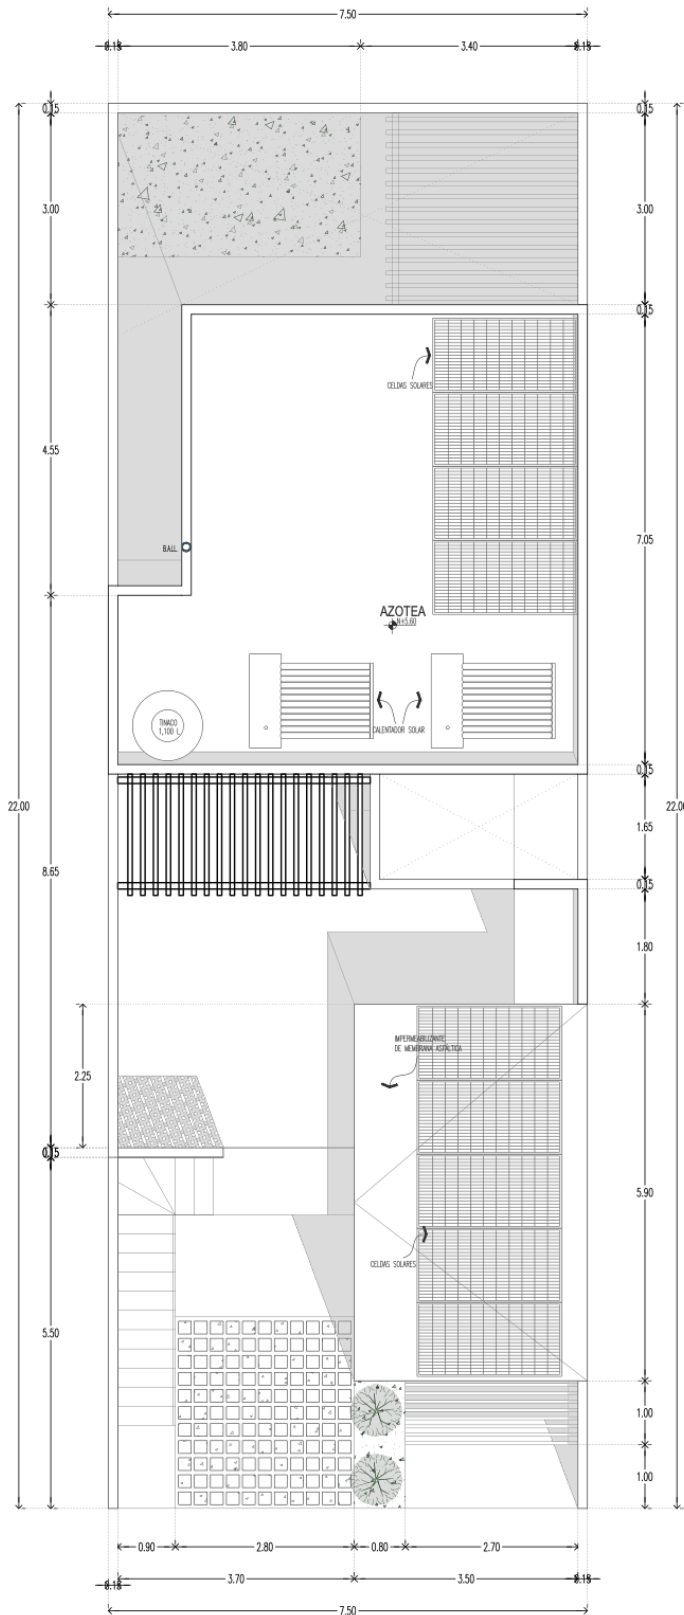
Planta de azotea de la vivienda, etapa 3b.
